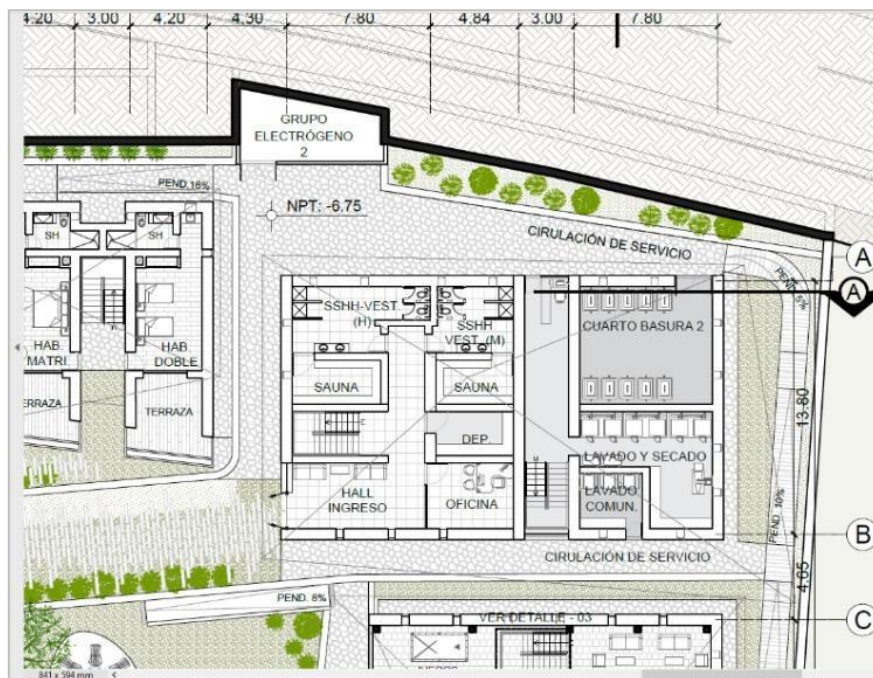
Primer nivel que separa sauna, área de lavado y cuarto de basura
